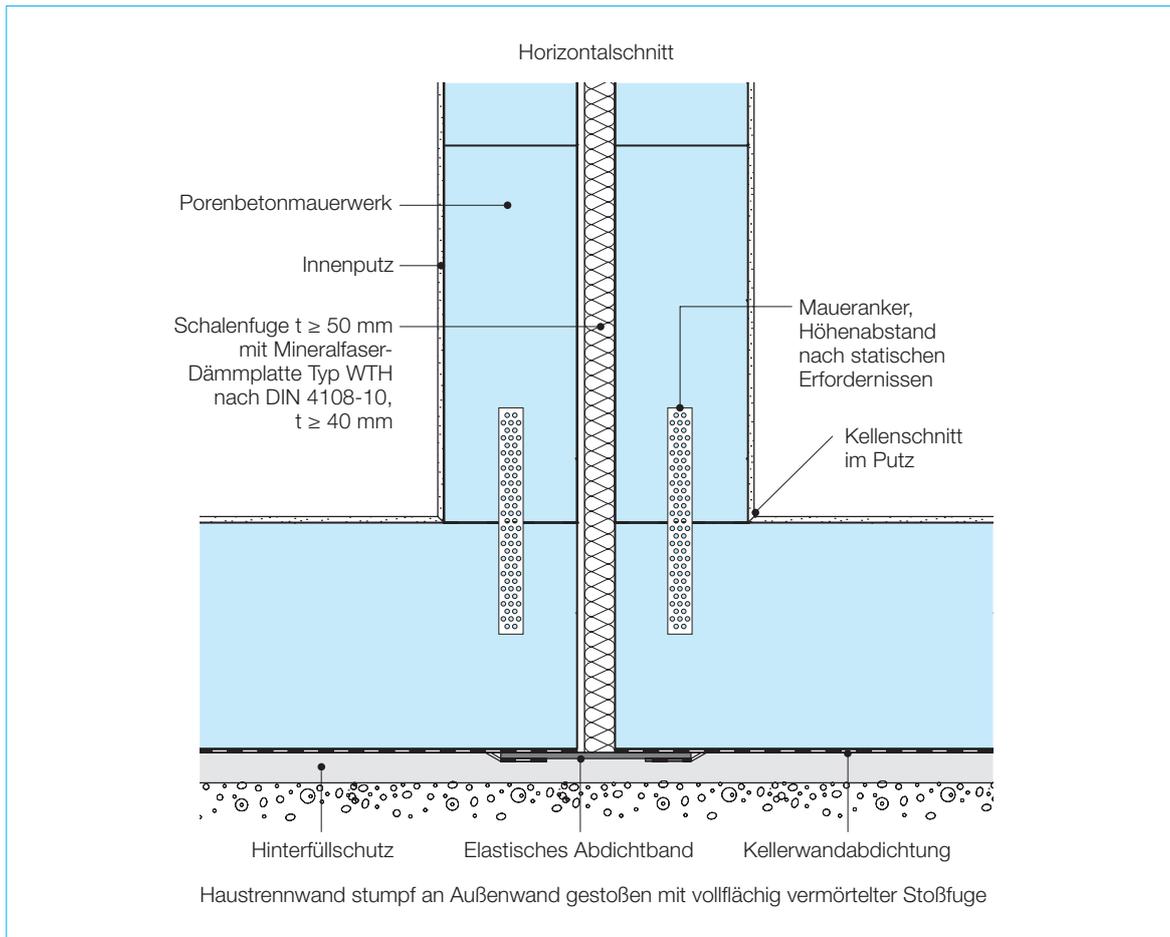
Anschluss einer zweischaligen Haustrennwand aus Porenbetonmauerwerk an eine Kelleraußenwand aus Porenbetonmauerwerk (vertikale Kellerwandabdichtung)
